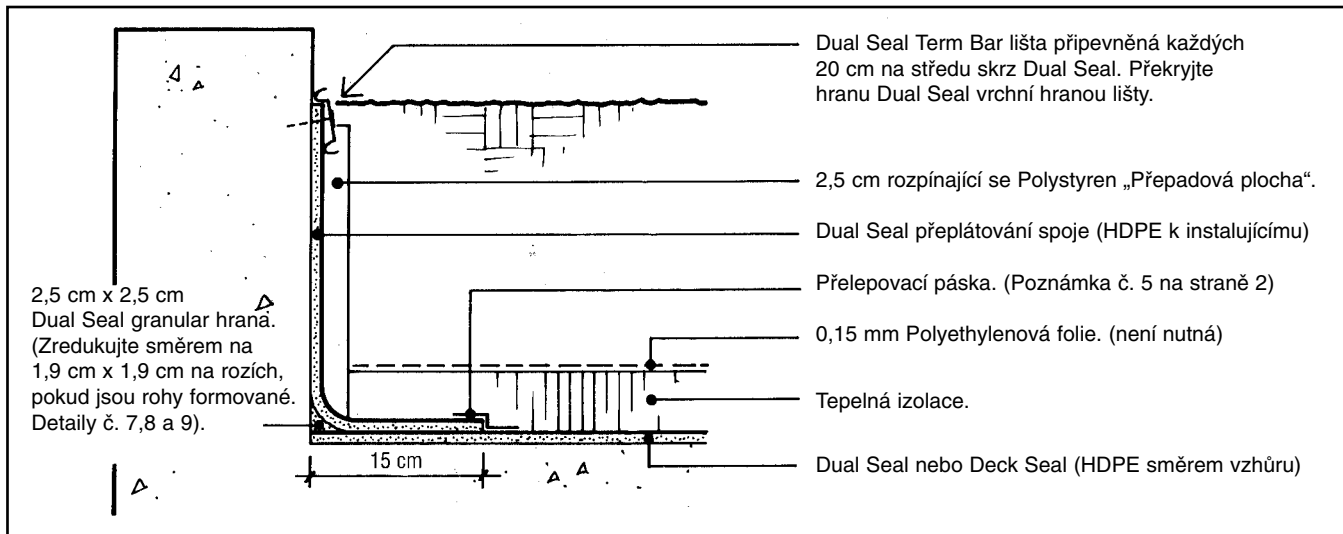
Izolace cihelného zdiva s uzemněním.
